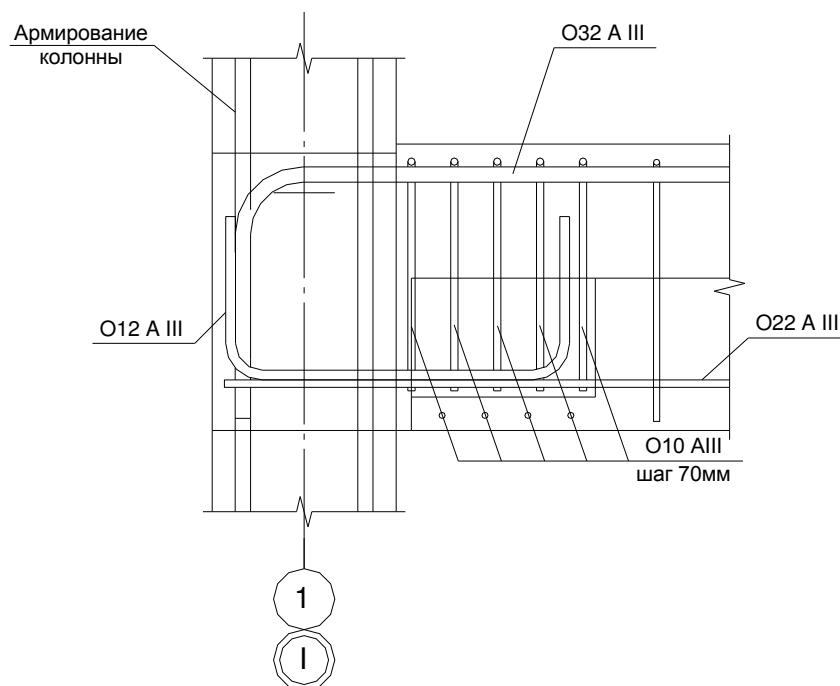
Схема армирования ригеля на опоре пролета
